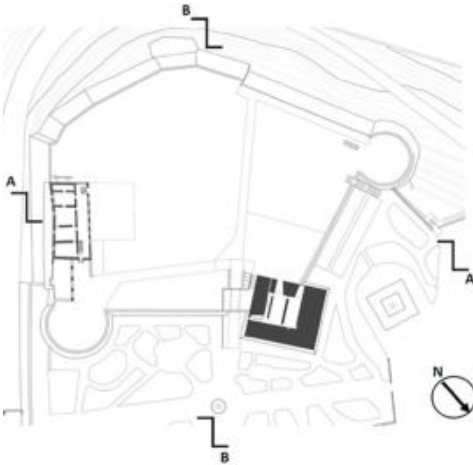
D. Falcioni, M. Mencarelli, Planimetria della Rocca di Camerino nello stato precedente al terremoto del 2016, 2021
